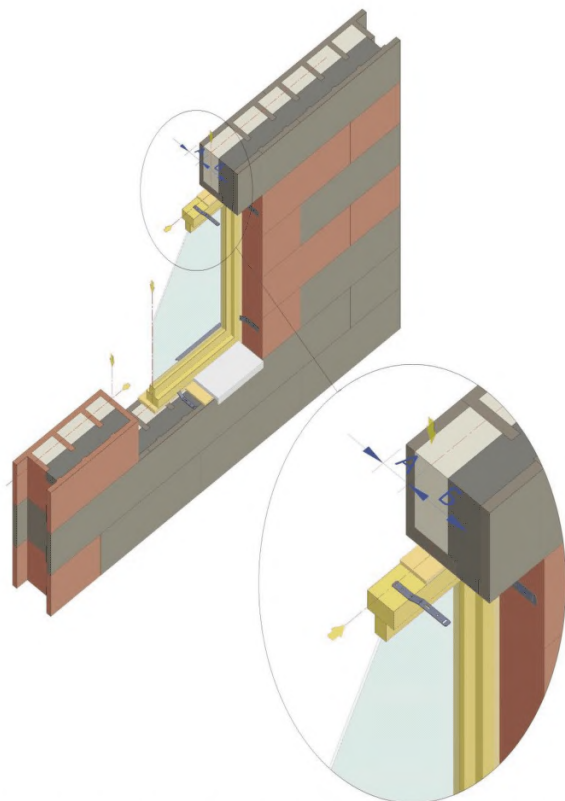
Схема установки оконных блоков в проеме кладки наружной стены
